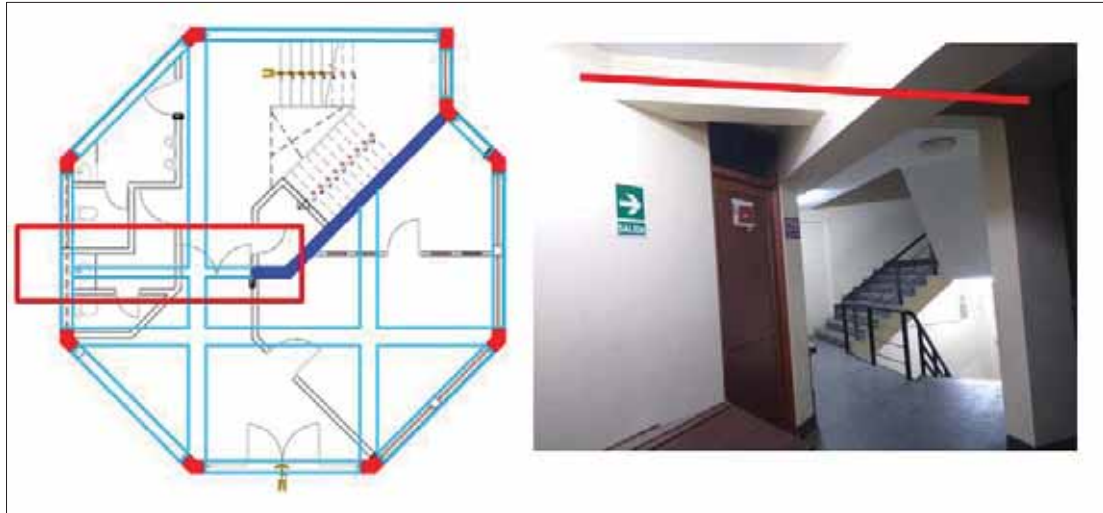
Sistema estructural aporticado con un muro estructural. Sistema de cargas continuo hasta la cimentación
